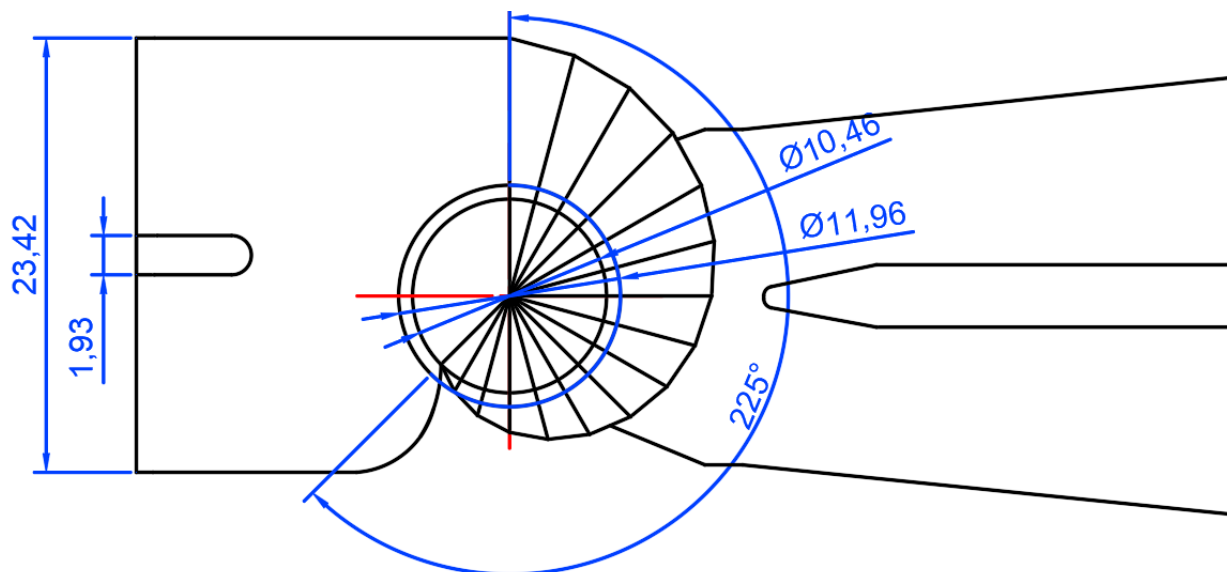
План спиральной камеры ПЛ50-В-800
